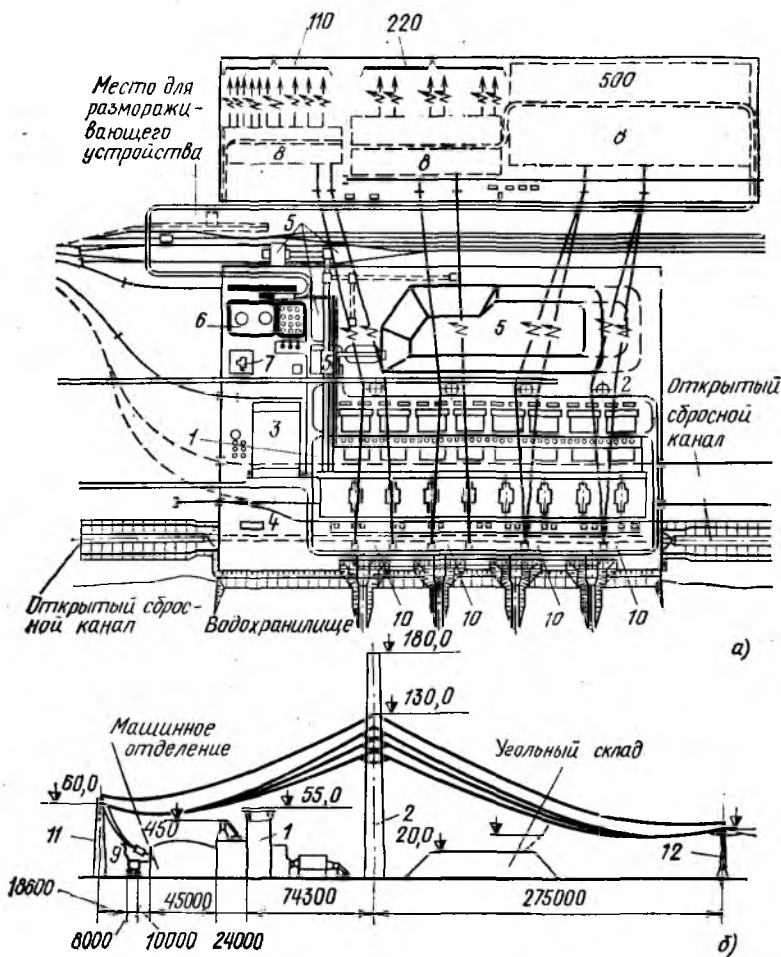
Схема генерального плана типовой КЭС 2400 МВт (вариант с размещением открытого распределительного устройства за угольным складом) (а) и переход электрических линий через главный корпус (б):
